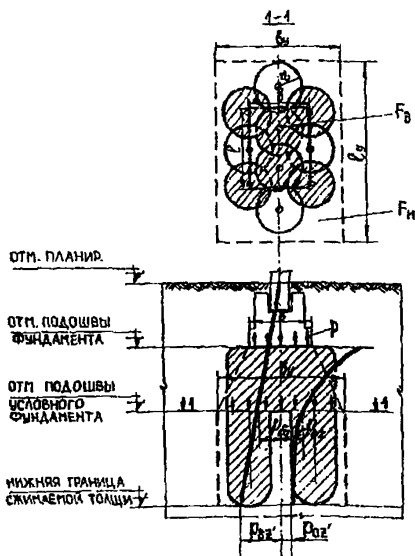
Схема к расчету осадки фундамента при комбинированном закреплении грунтов основания
